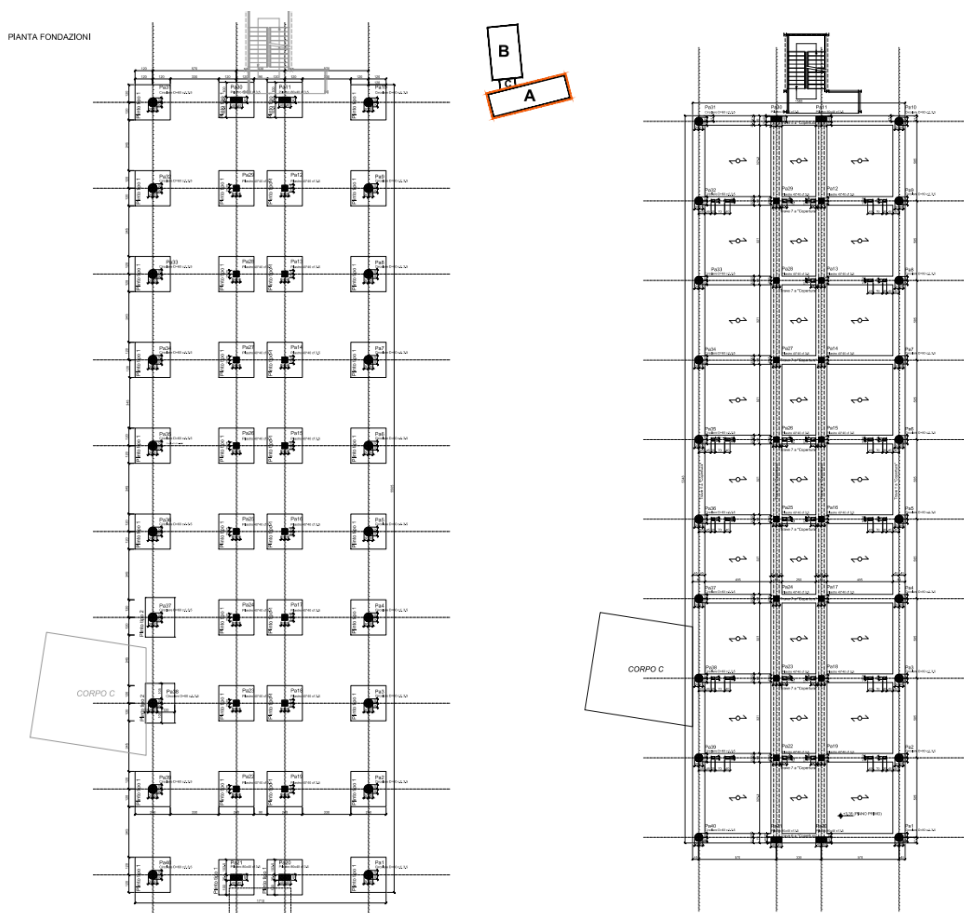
Pianta fondazioni (sinistra) e piano primo (destra) corpo A
